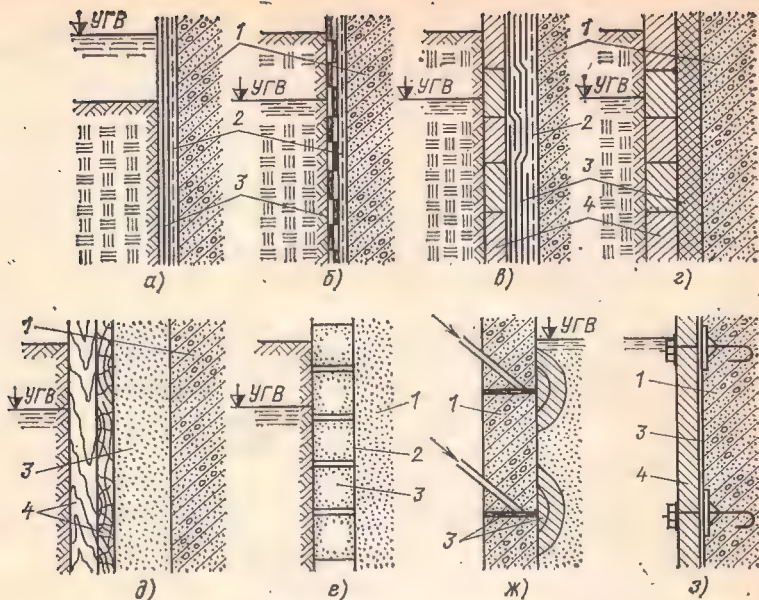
Типы поверхностных гидроизоляционных покрытий:
